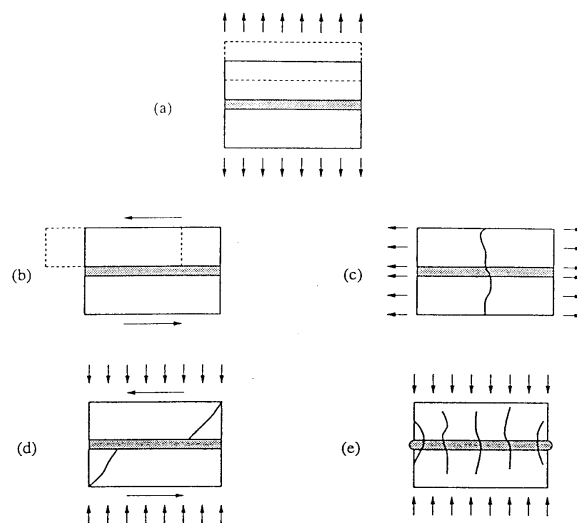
Mecanismo de fallo de la mampostería: (a) Fisuración por tracción; (b) Deslizamiento por junta; (c) Fisuración del ladrillo por tracción directa; (d) Fisuración diagonal del ladrillo por tracción; (e) Fisuración por "Masonry crushing".
